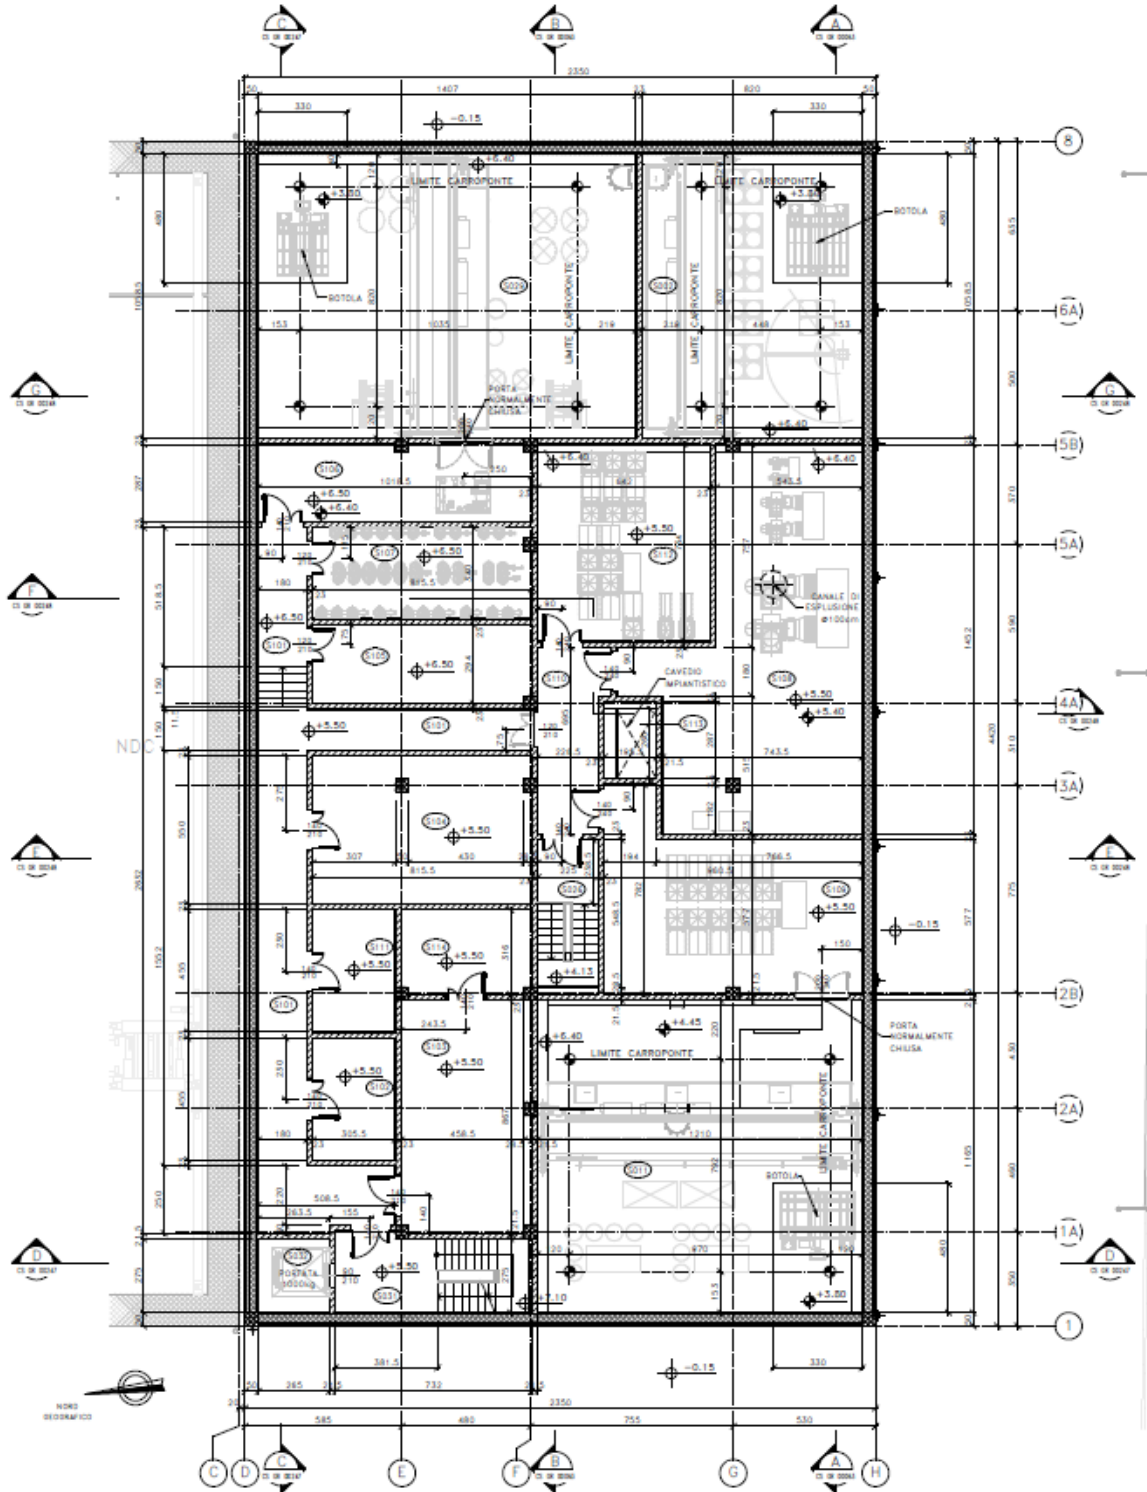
Pianta Piano Primo (CS GR 00060)
